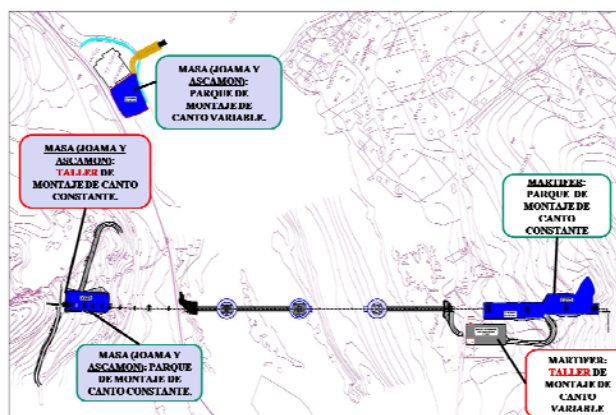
Ubicación de talleres de ensamblaje de piezas y parques de montaje a pie de obra.
